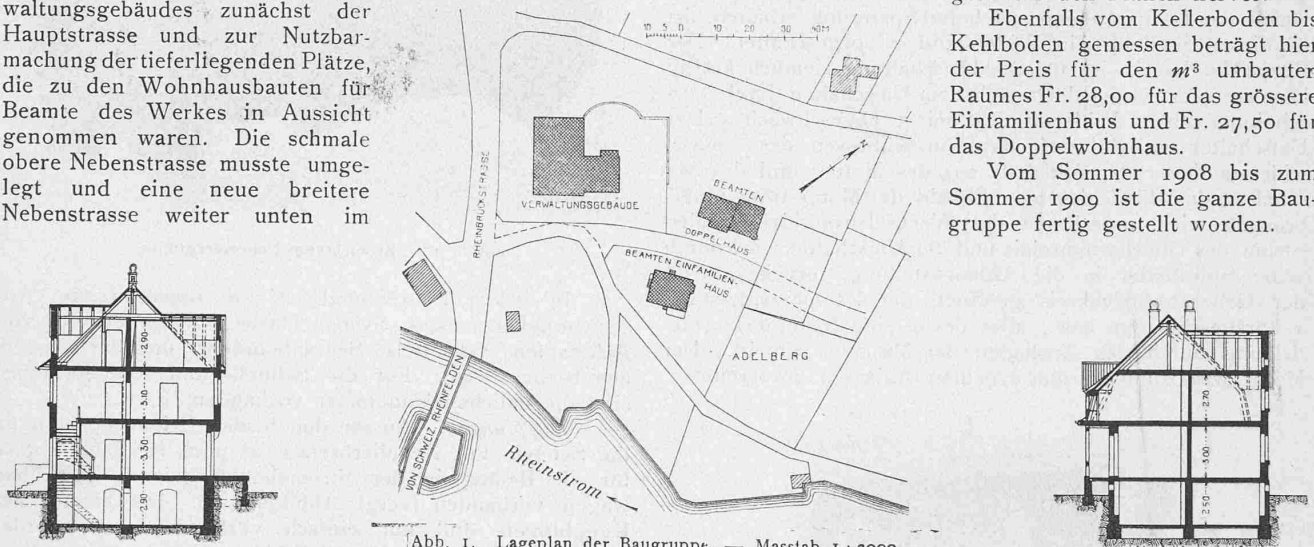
Lageplan der Baugruppe. — Masstab 1 : 2000.
